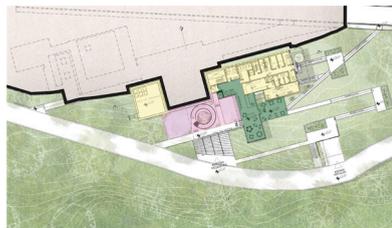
Figura X: Planta Baixa Térreo | Fonte: Arq. Vinicius Breda
